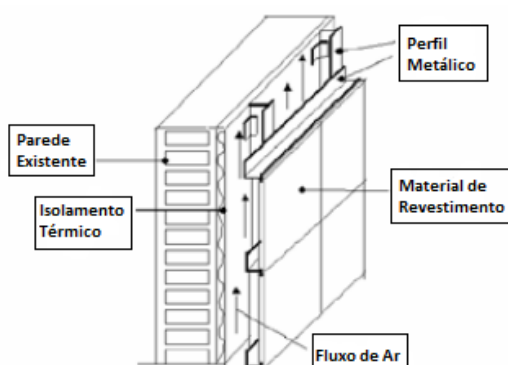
Representação esquemática de uma fachada ventilada (adaptado de [17]).
